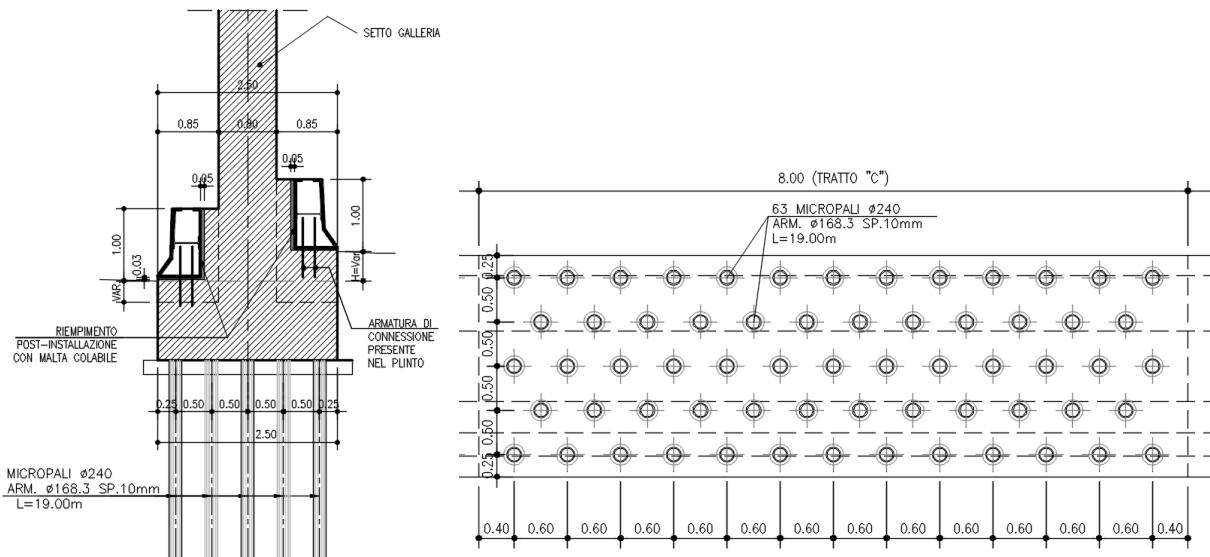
Zona di transizione a ridosso dello scavalco
